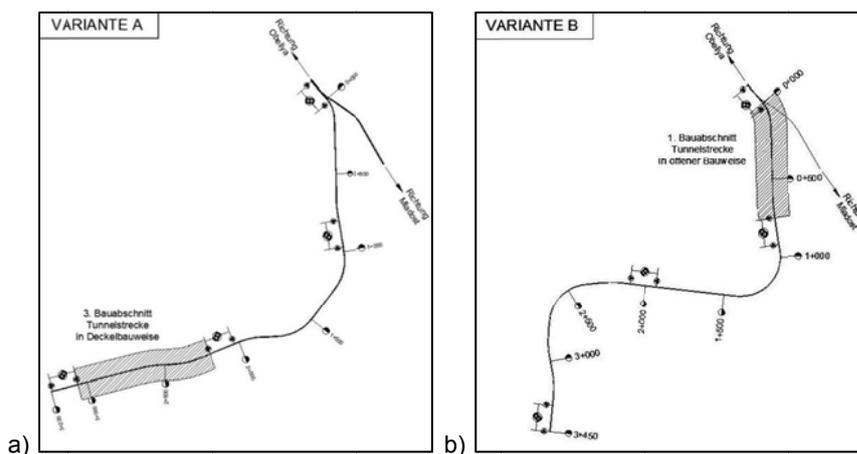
Lage der betrachteten Baulosen – a) Variante A – 3. Baulos (Deckelbauweise); b) Variante B – 1. Baulos (offene Bauweise)
